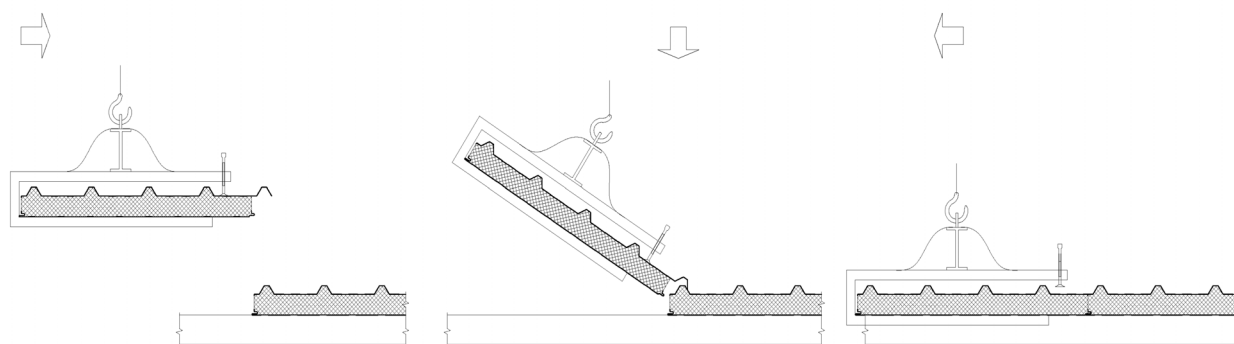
Способ монтажа кровельных сэндвич-панелей с высоким гофром
